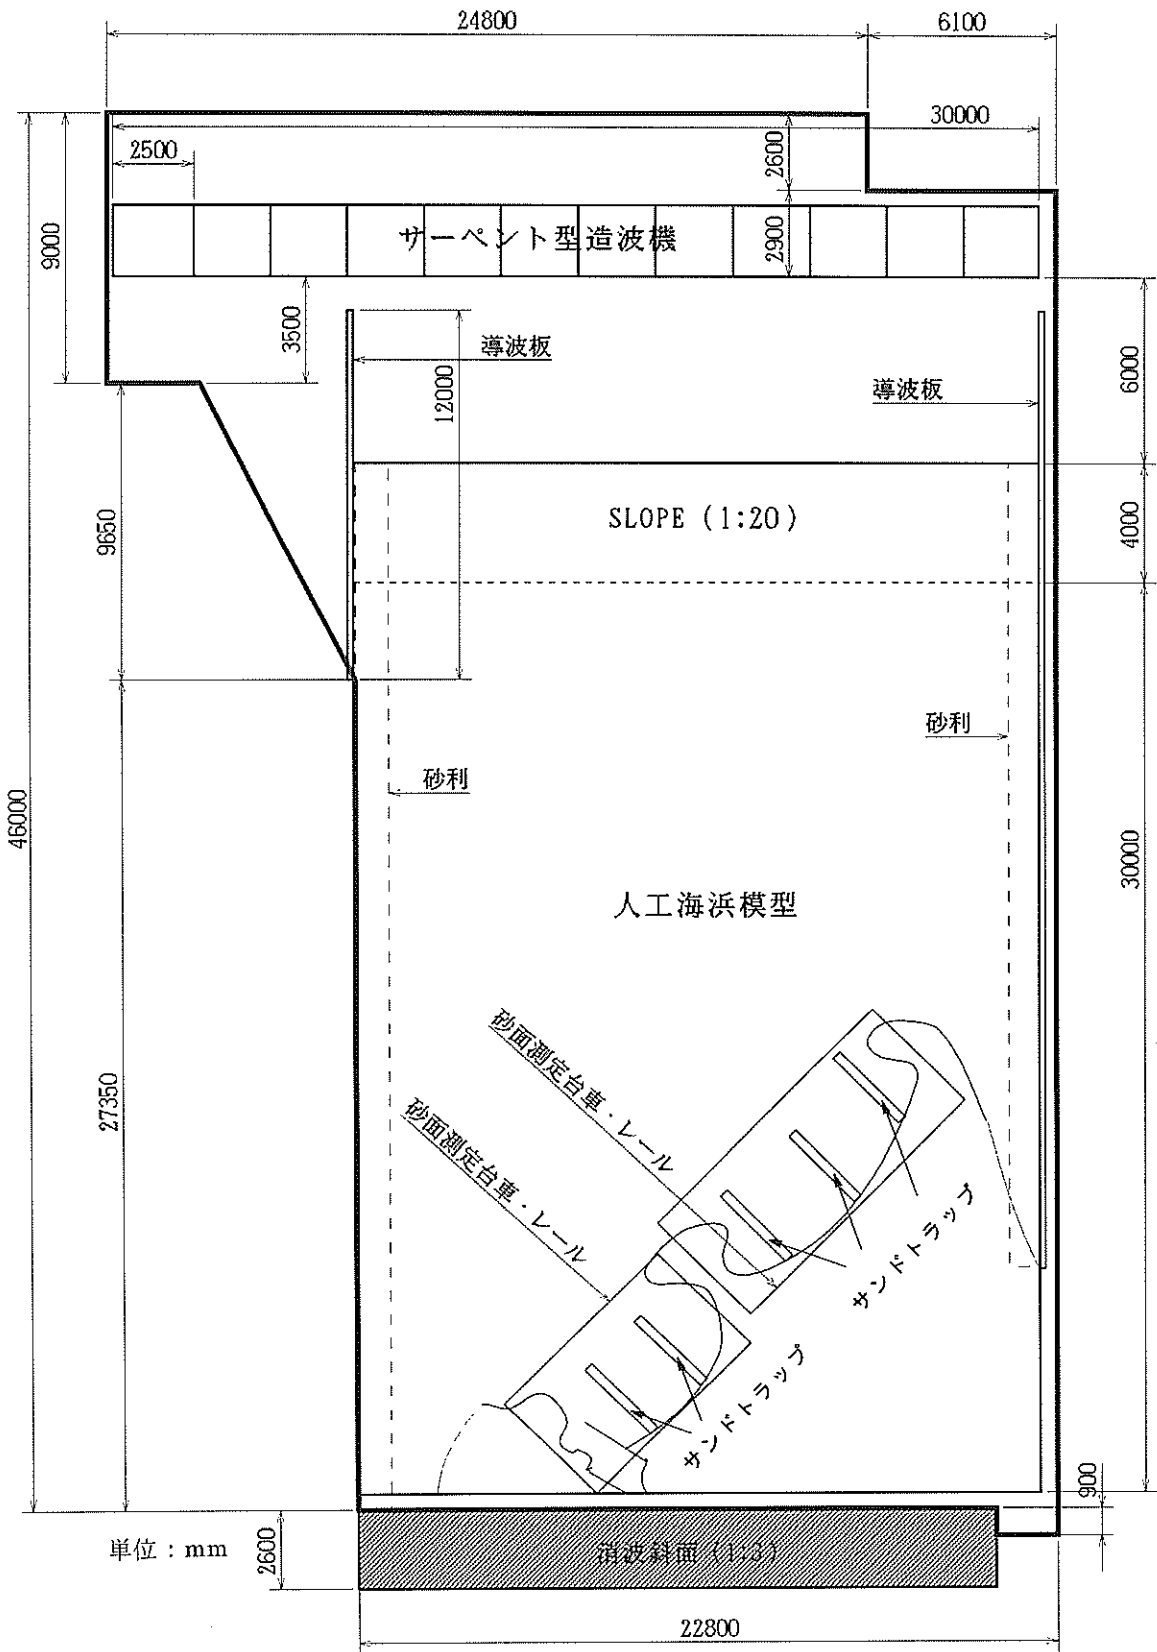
2 水槽設置平面図 (運輸省港湾技術研究所・大型水工実験水槽)
